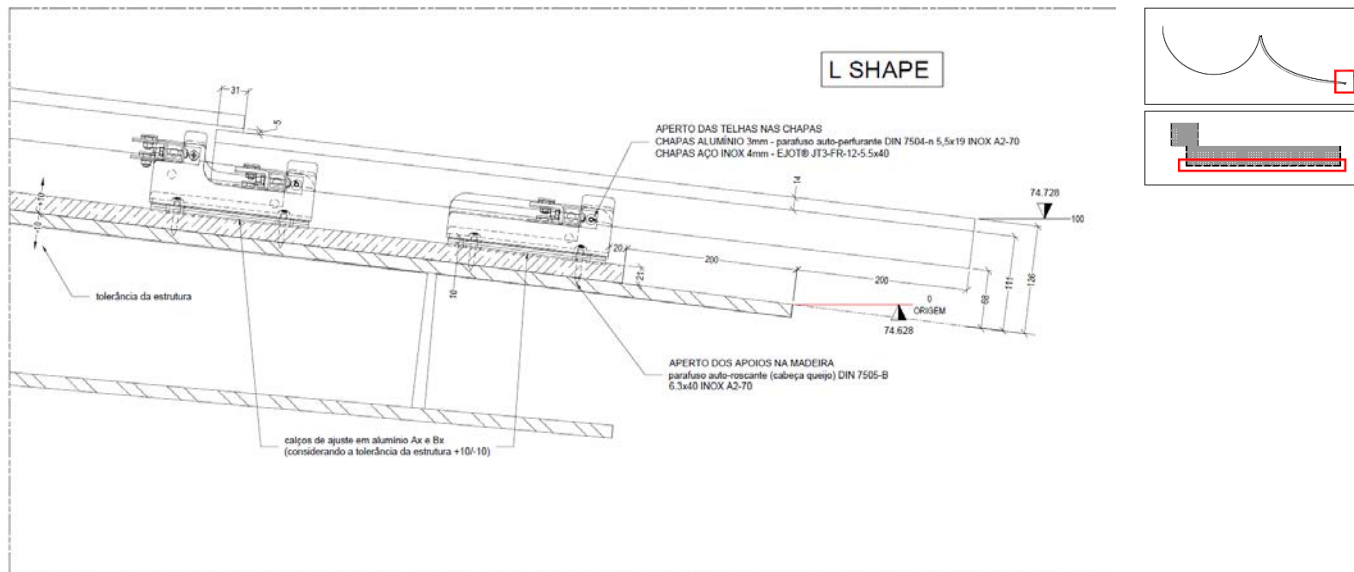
Pormenor construtivo exemplificativo da instalação do sistema de revestimento da pala da estrutura ENGAWA na zona de bordo.
